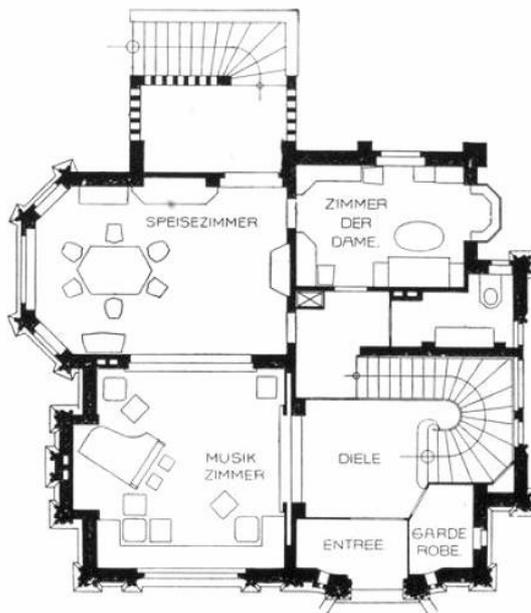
Planta do primeiro piso da *Peter Behrens House*, Darmstadt, 1901
